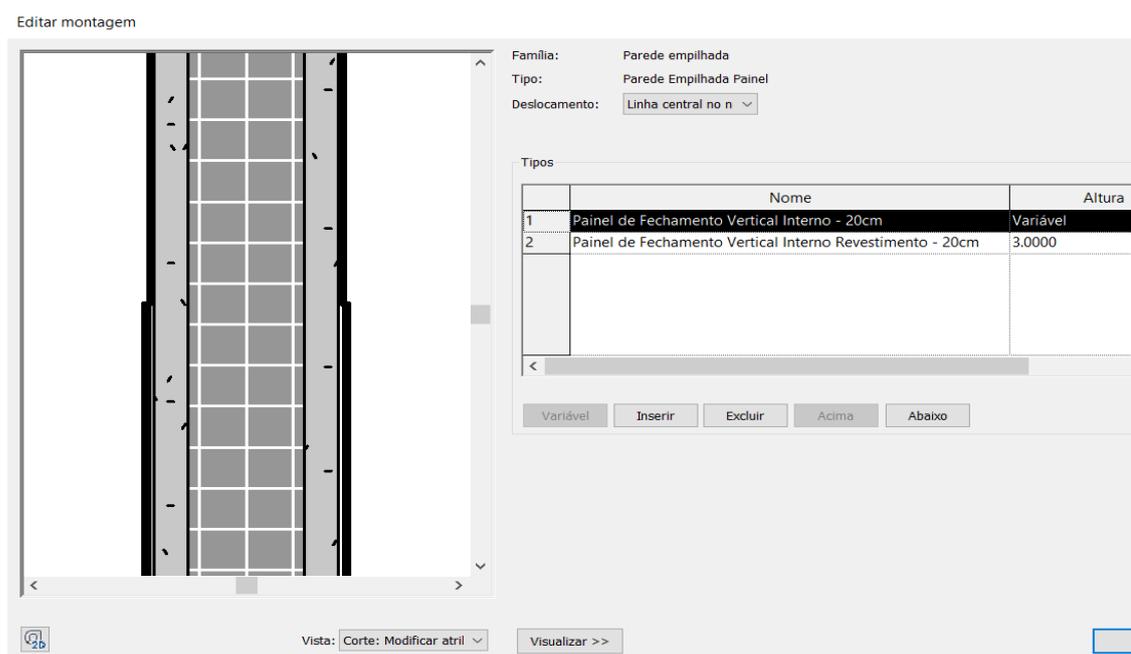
Composição de elemento – parede drywall resistente à umidade
